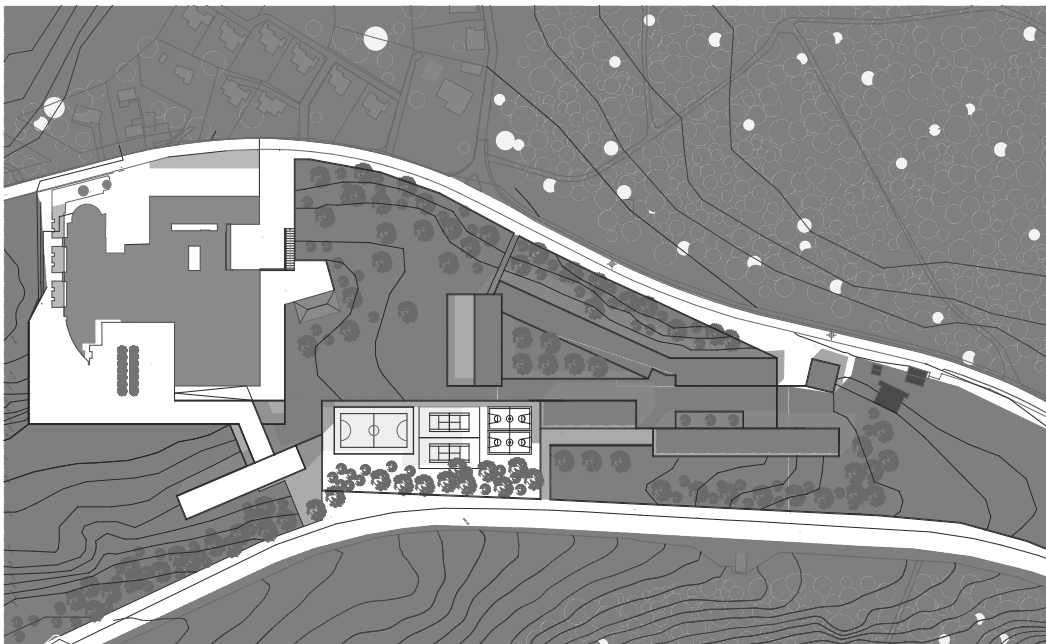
Planta apresentação à crítica, escala 1/500.
